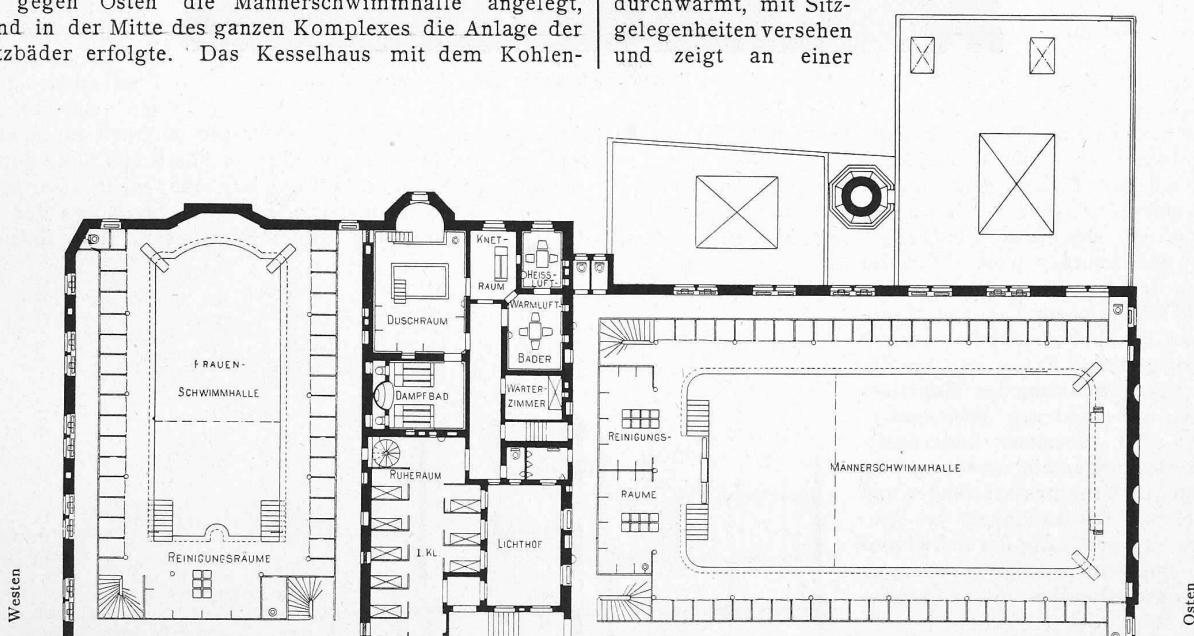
Grundriss vom I. Obergeschoss. — Masstab 1:400.
